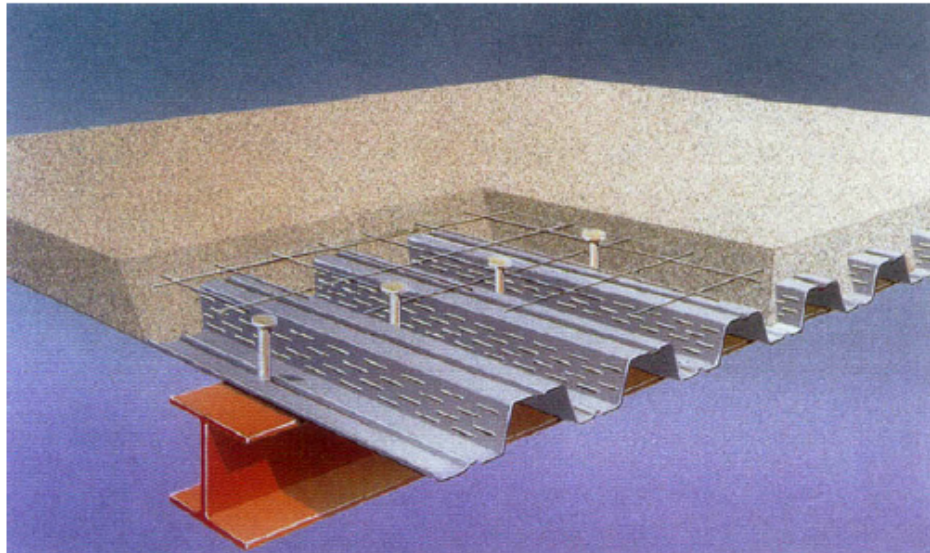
Exemplo do sistema de lajes mistas - Steel Deck CE-75
